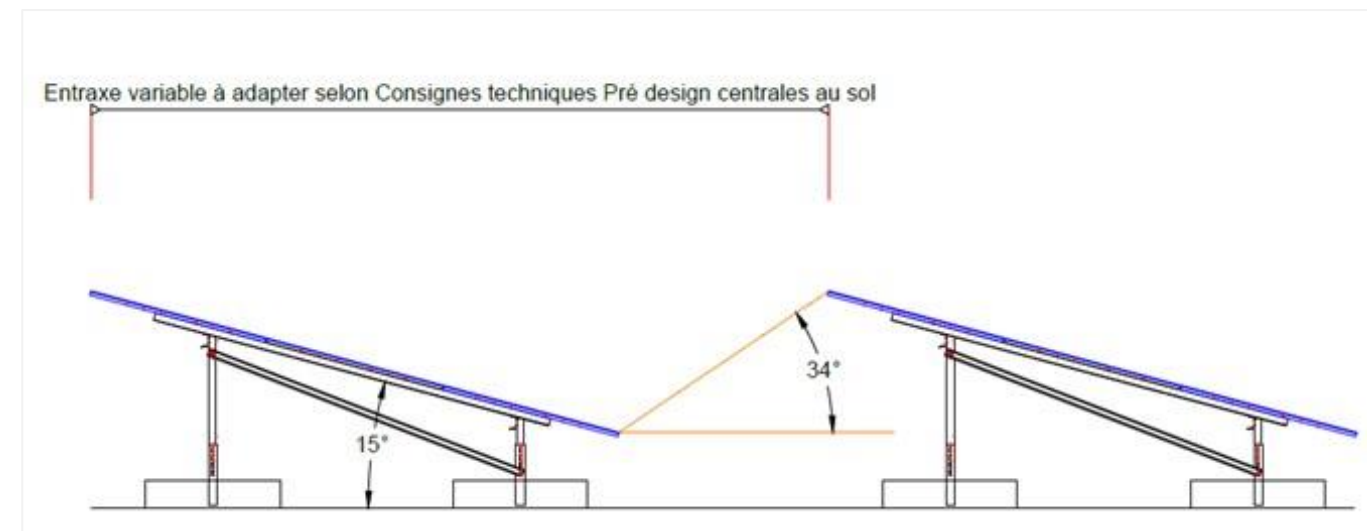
Plan de façade d'une table photovoltaïque (Source : Urbasolar)
